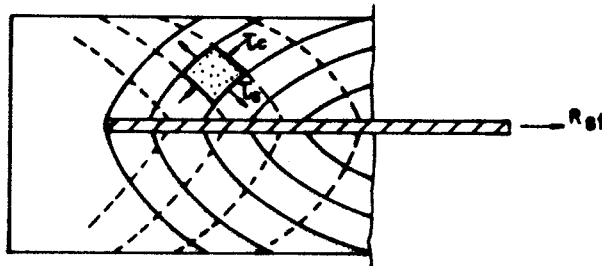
Tensões no concreto devidas à ancoragem.
